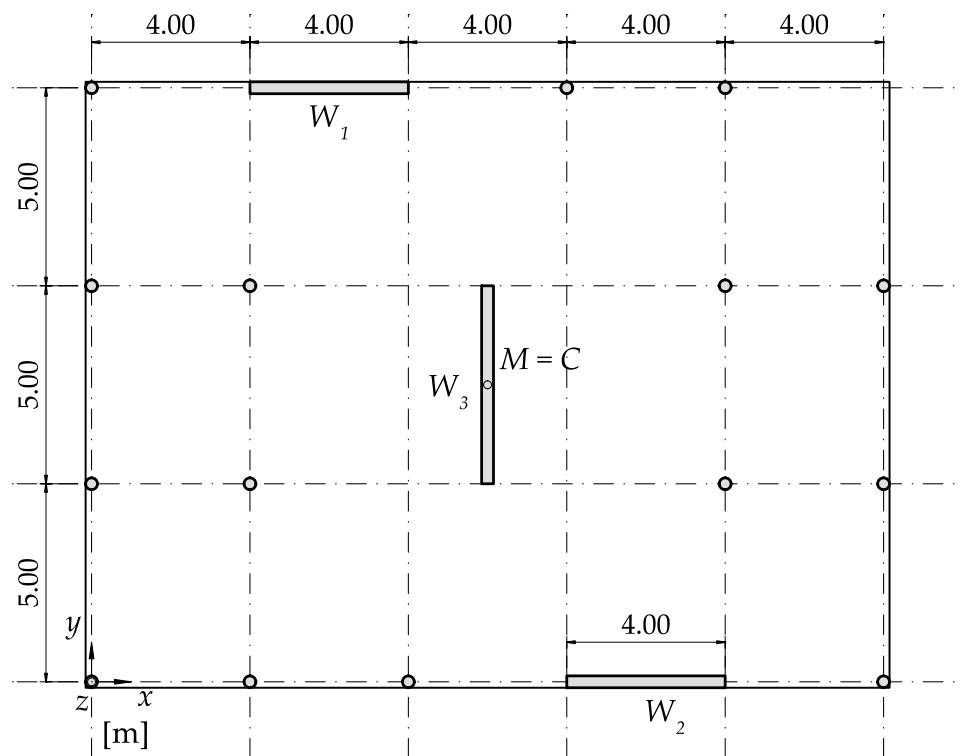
Grundriss des Gebäudes
